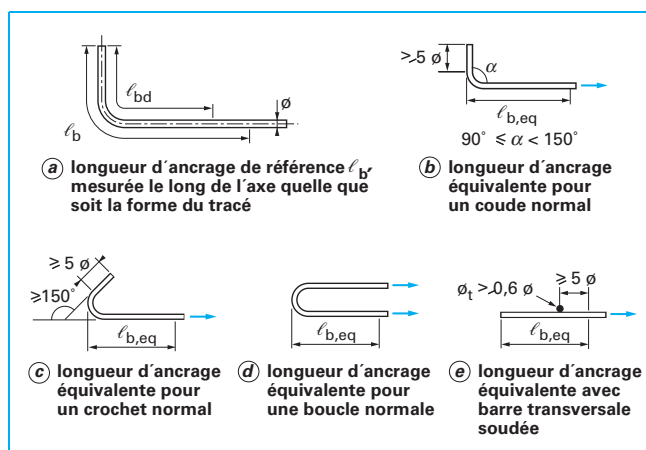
Modes d'ancrage autres que le scellement droit (figure 8.1 de l'EC2)
